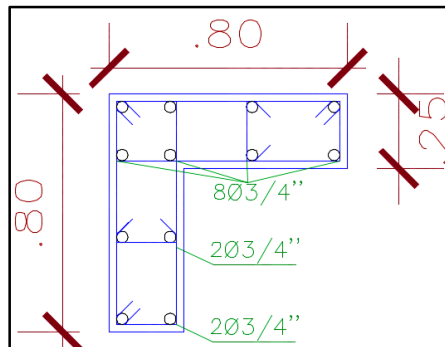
Detallado de acero de la columna "B3" - Sistema dual tipo II
